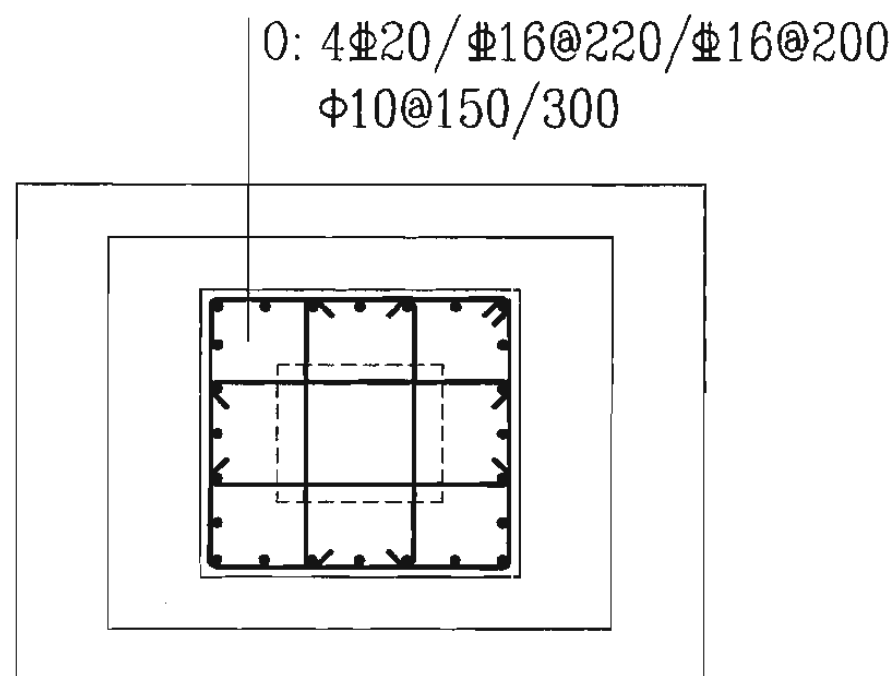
高杯口独立基础杯壁配筋示意
